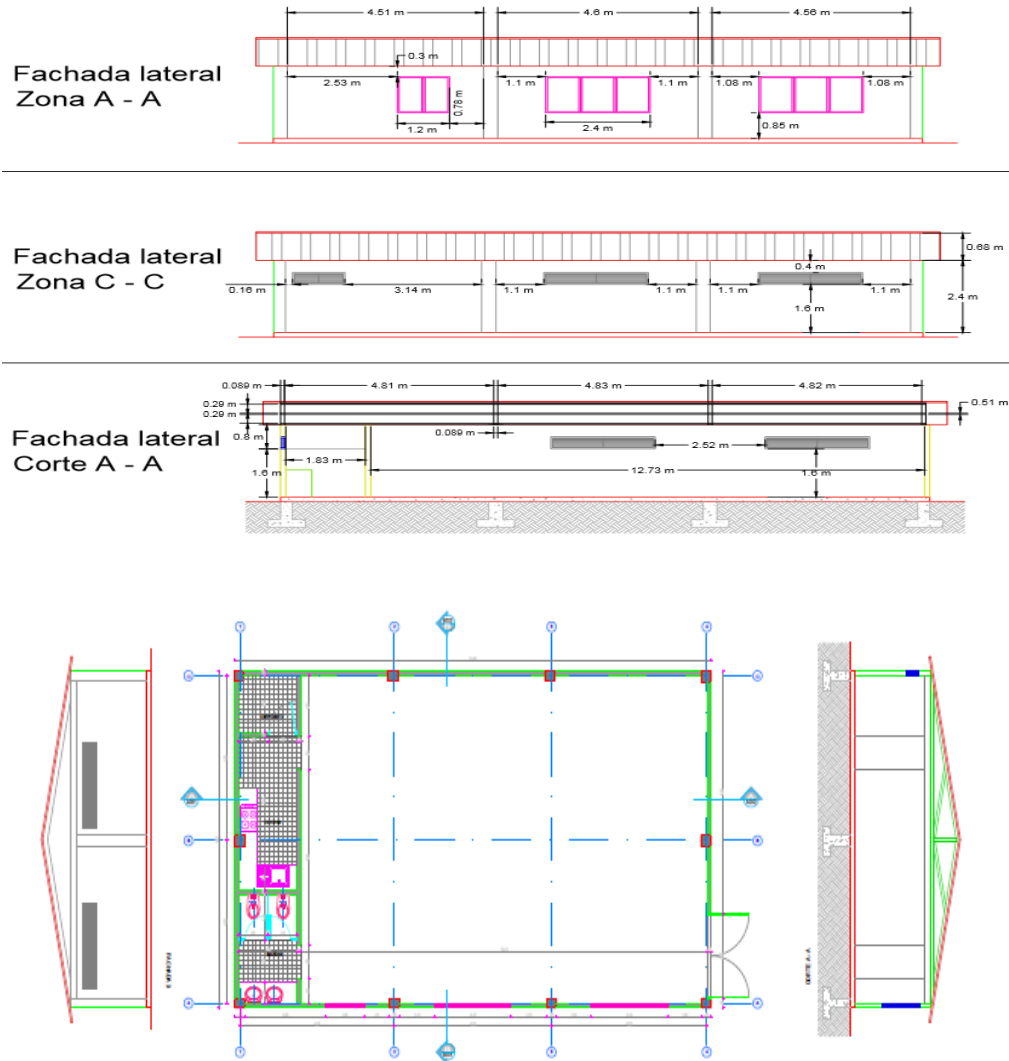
Plano arquitectónico proyecto “Verbenal Sueña”
